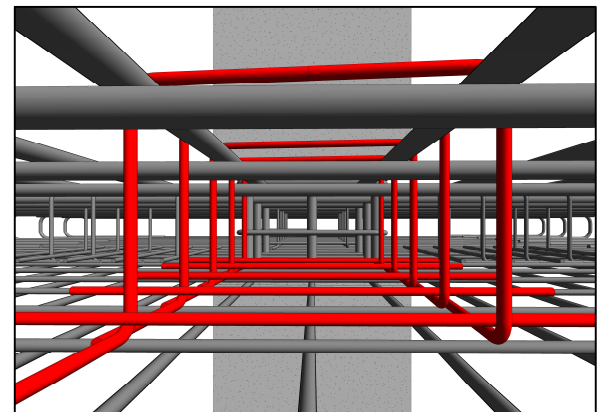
Detalhe do estribo “caranguejo” na laje CTA.
